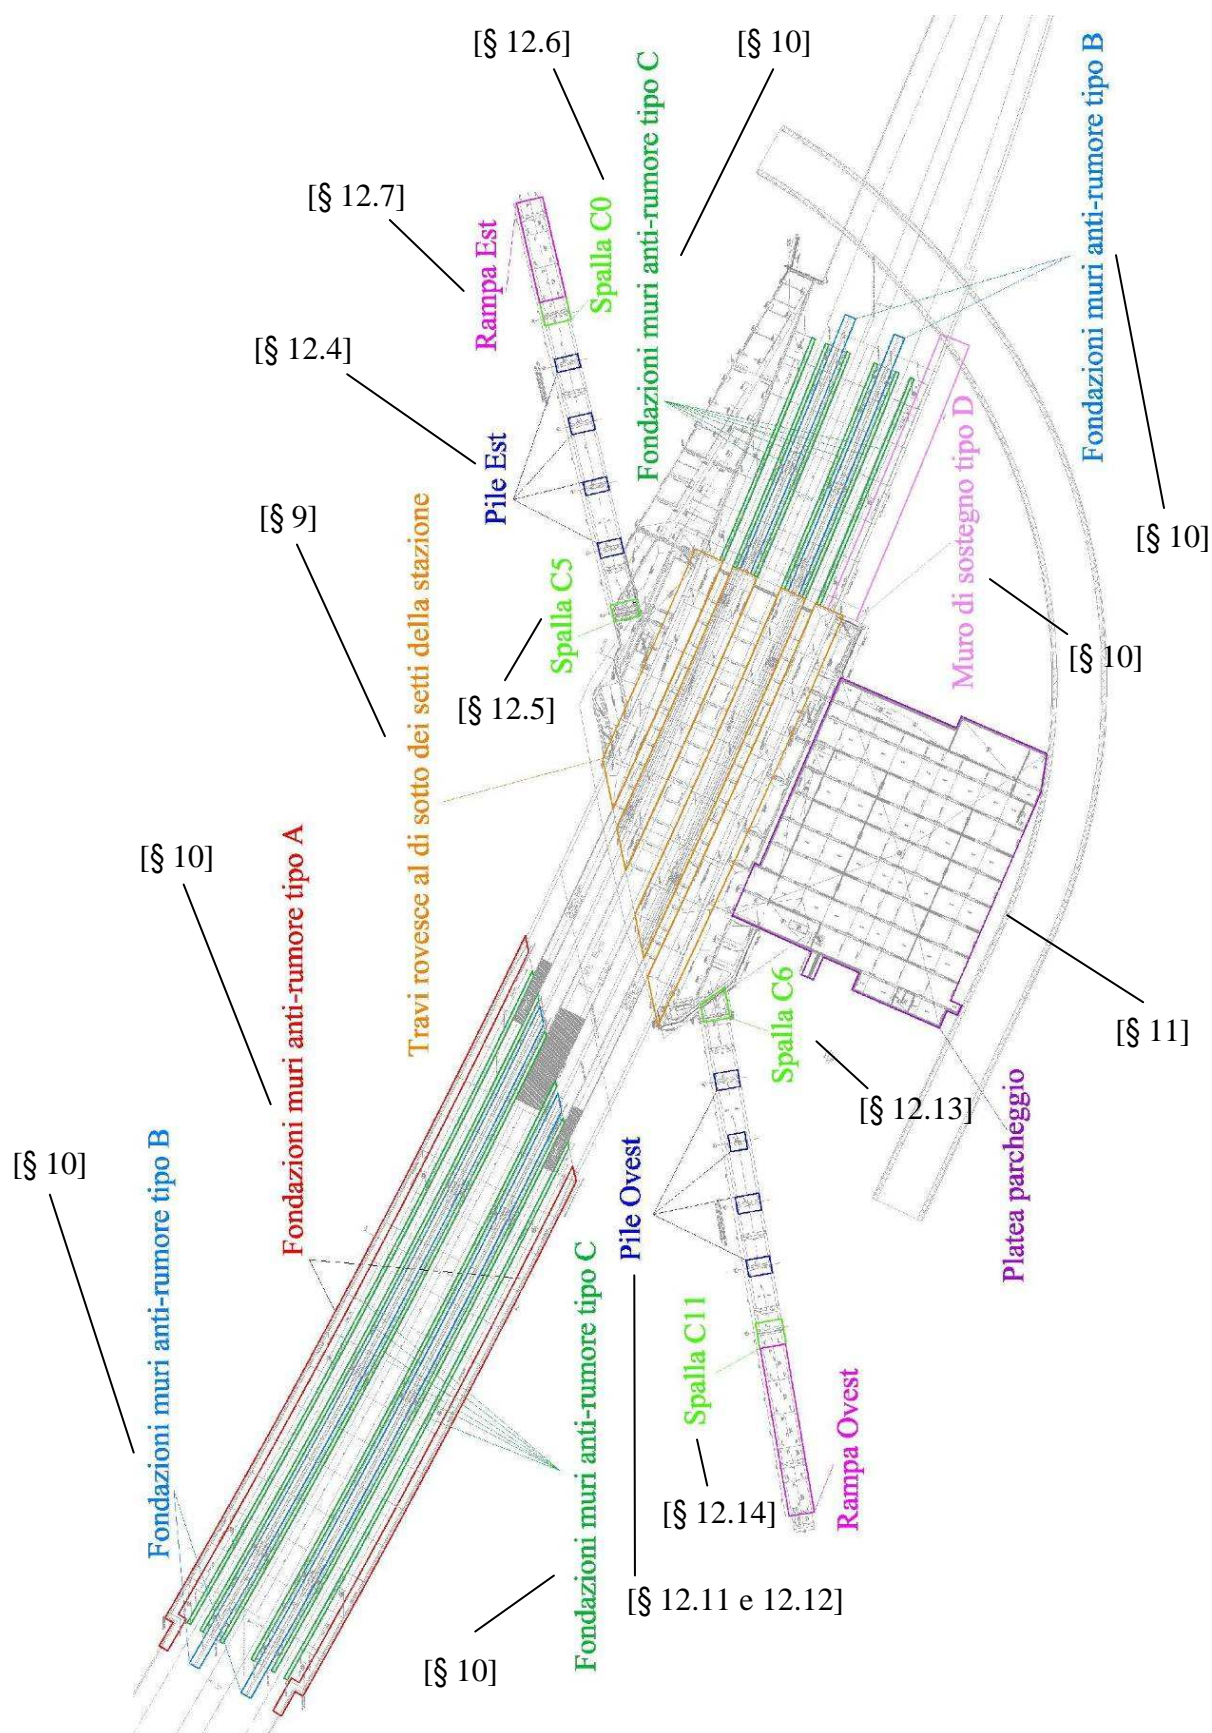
individuazione delle opere di fondazione sulla planimetria generale.
